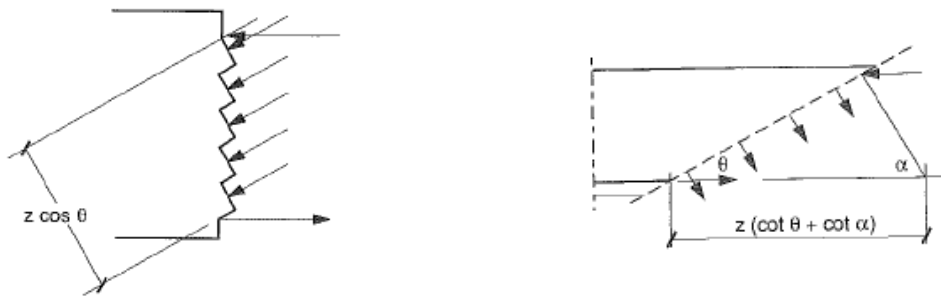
Compresión del hormigón en el alma y tracción en el acero del alma
